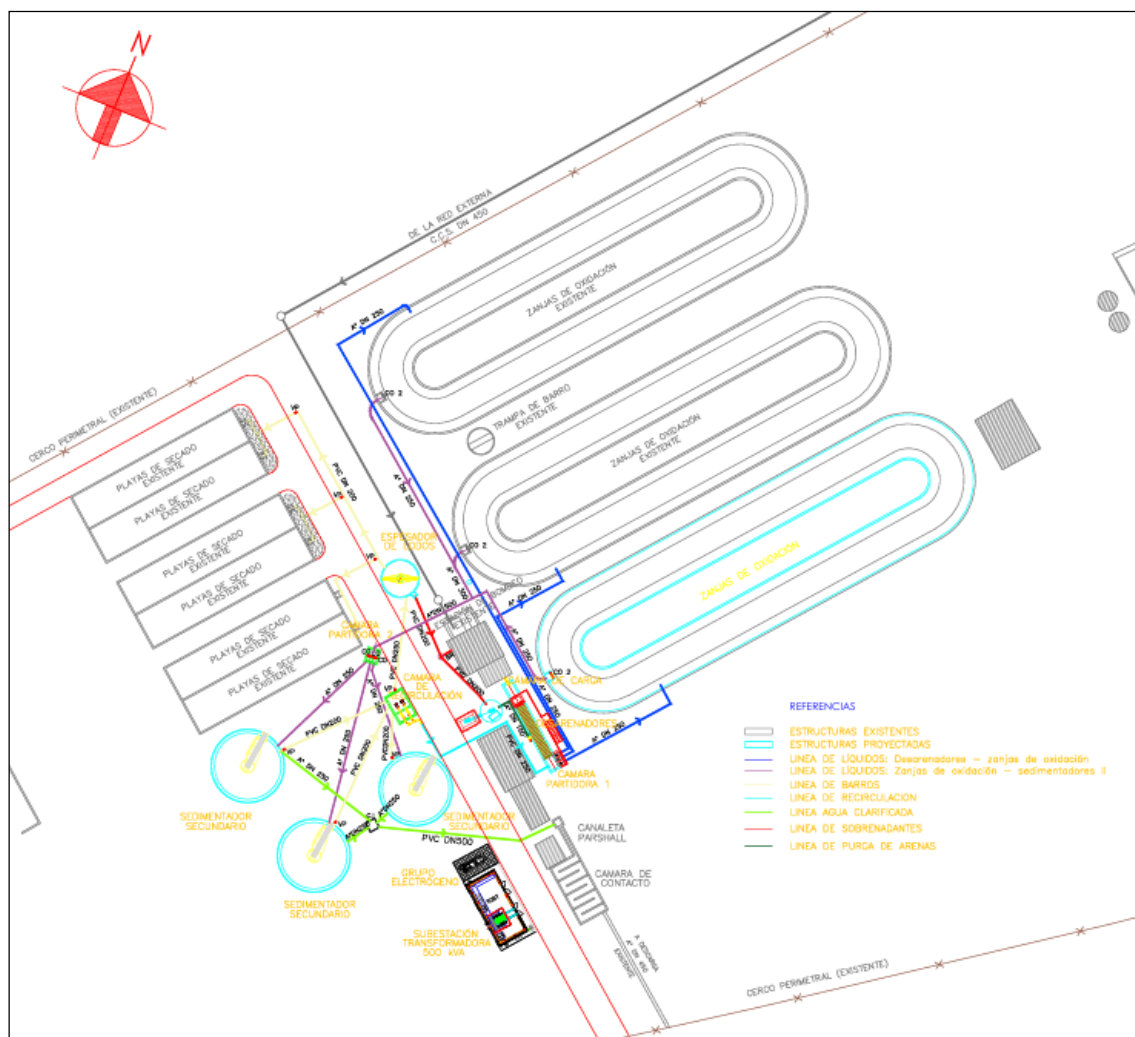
Vista en planta de la PTLC, en celeste las estructuras proyectadas
